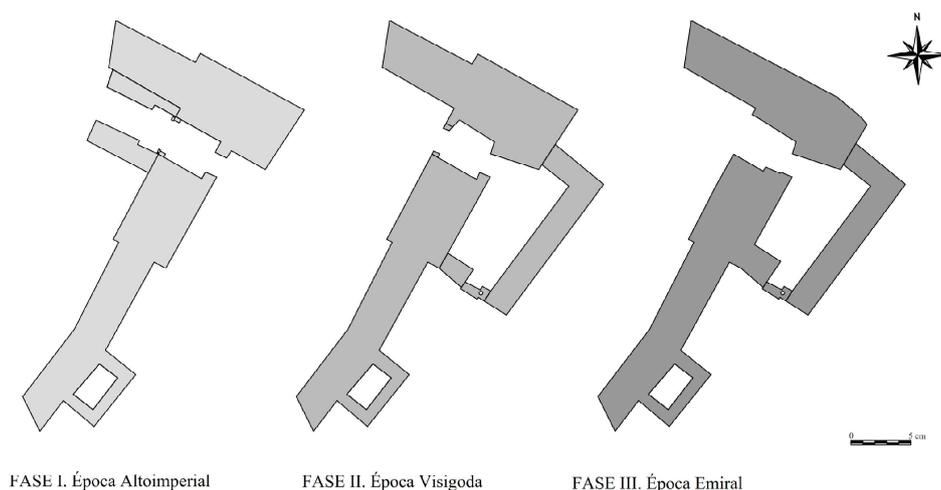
Planimetría con las fases de la puerta oriental de Begastri.
